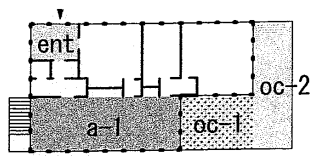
No. 13: Entwurf Das Wachsende Haus [HH. 54] 計画案1 1階
